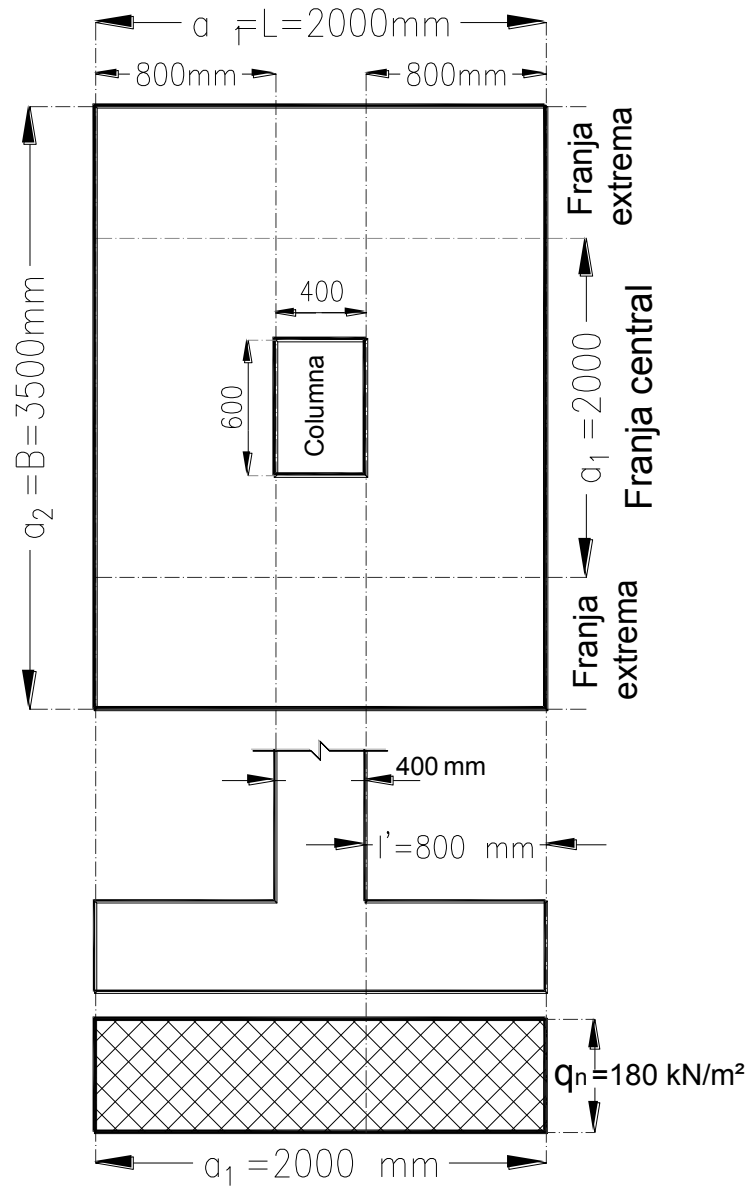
Distribución de franjas paralelas al lado menor de la zapata.
